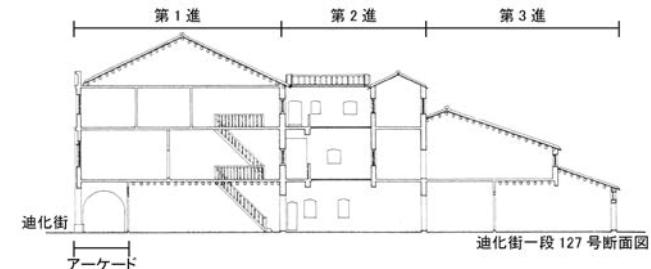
迪化街の店舗兼町家の断面図⁽¹⁾
